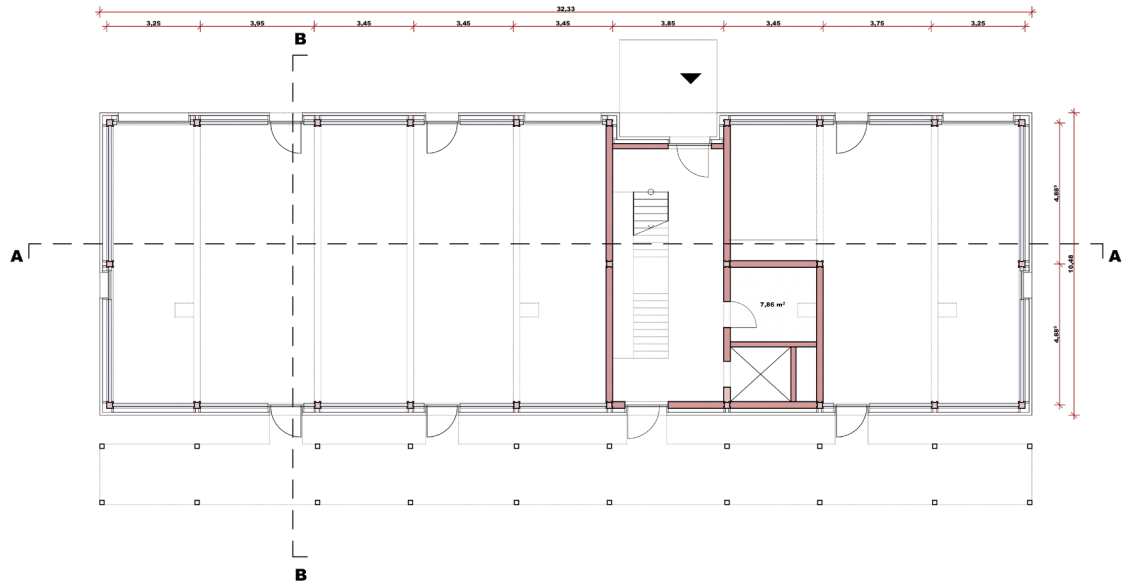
Erdgeschoss Grundrisse Referenzgebäude C
